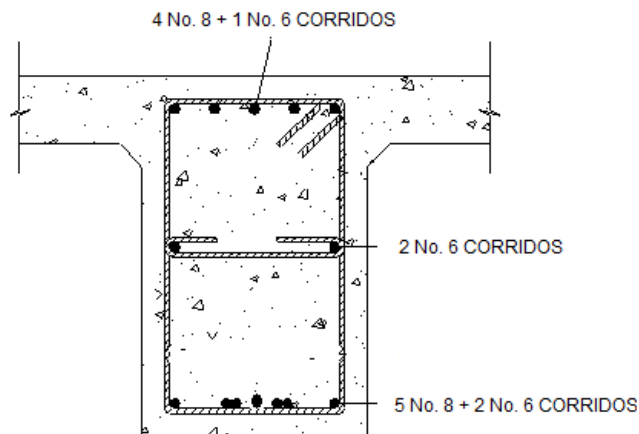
Detalle de refuerzo viga interna a 2.75 m del apoyo
